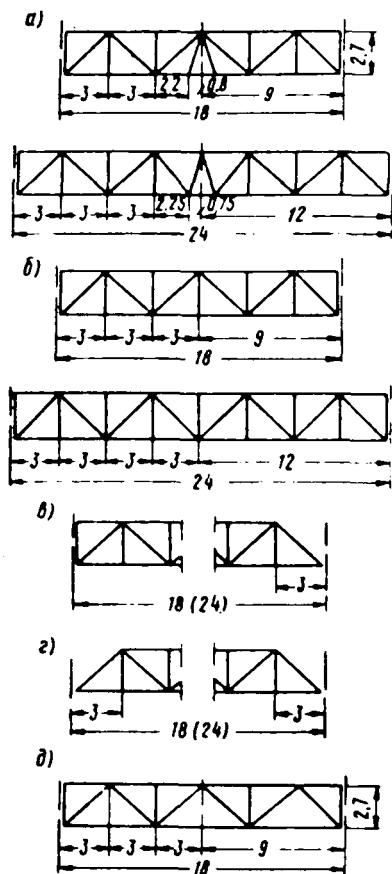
Схема ферм для зданий с плоской кровлей
